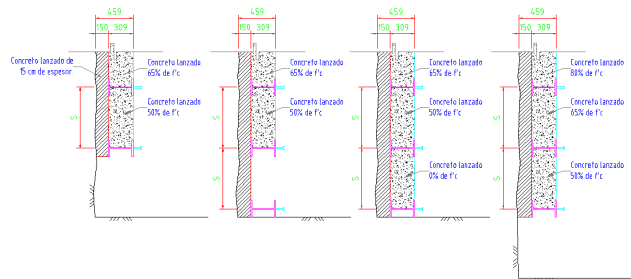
Secuencia constructiva del muro de concreto lanzado con anillos metálicos
